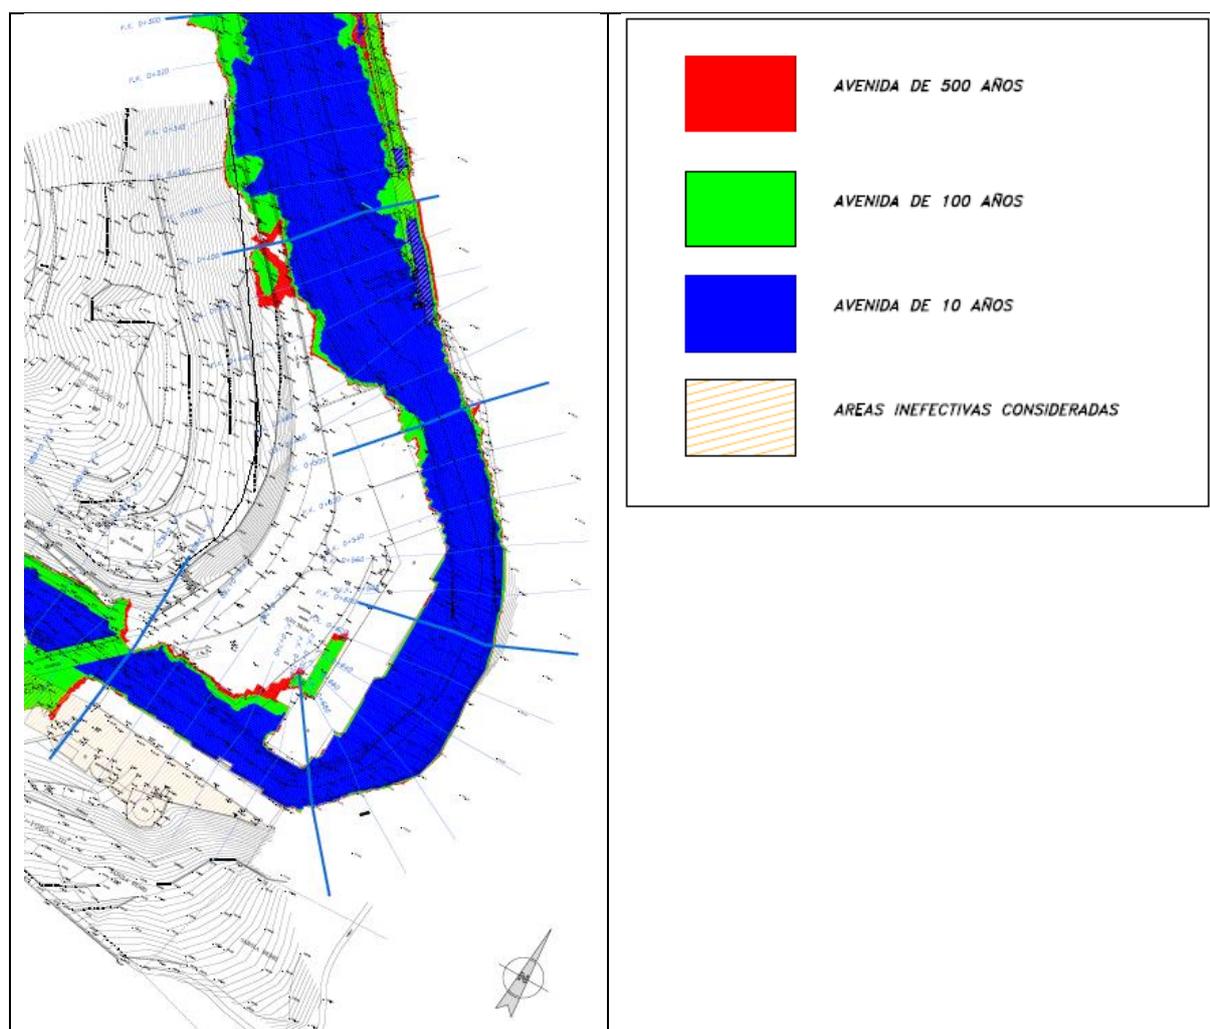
Planta de llanuras de inundación. Estado futuro. Fuente: Estudio hidráulico del río Araxes en Tolosa. Asmatu (2011).
